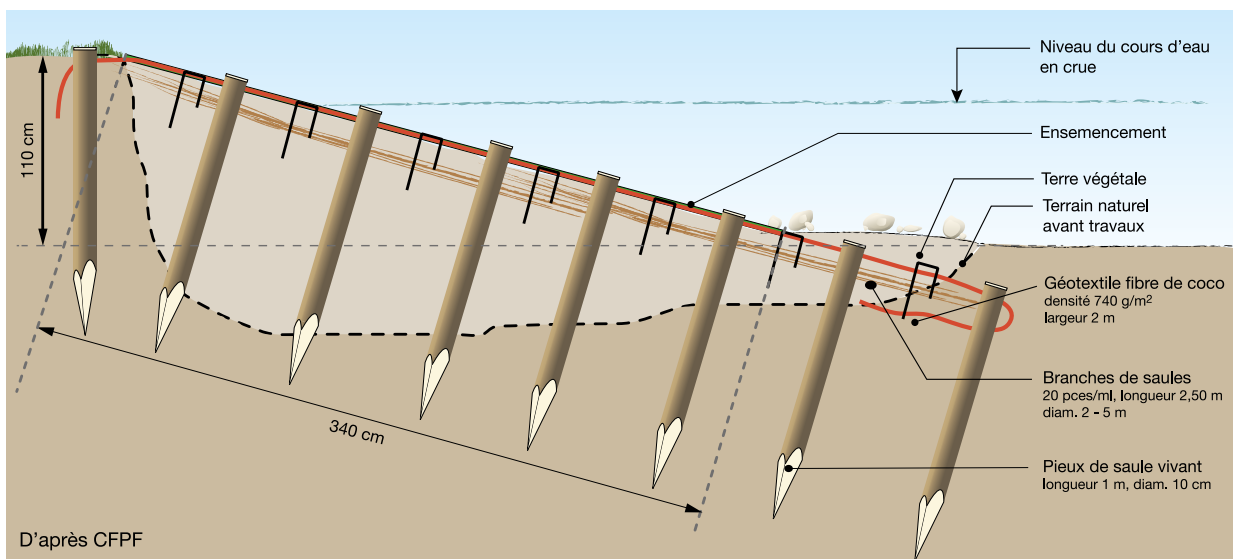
Coupe transversale sur les couches de branches à rejets.
